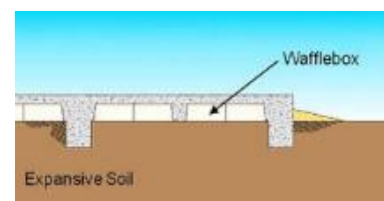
Бетонна плита на плавну, для нового будівництва
